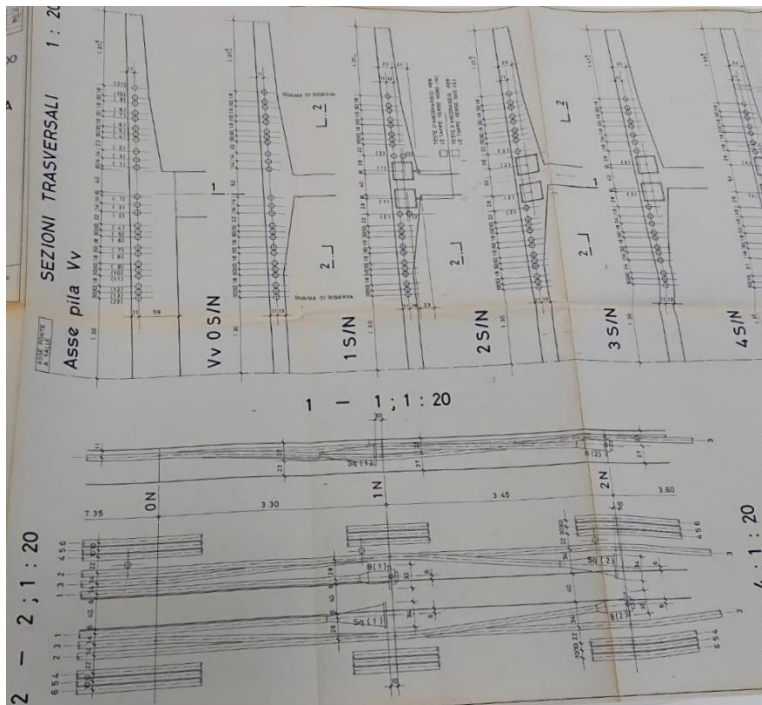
Plan der Armierung innerhalb des Brückenträgers
